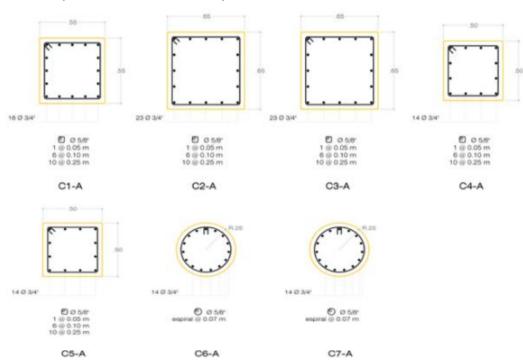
Diseño de columnas Sección A (Zona 1)
